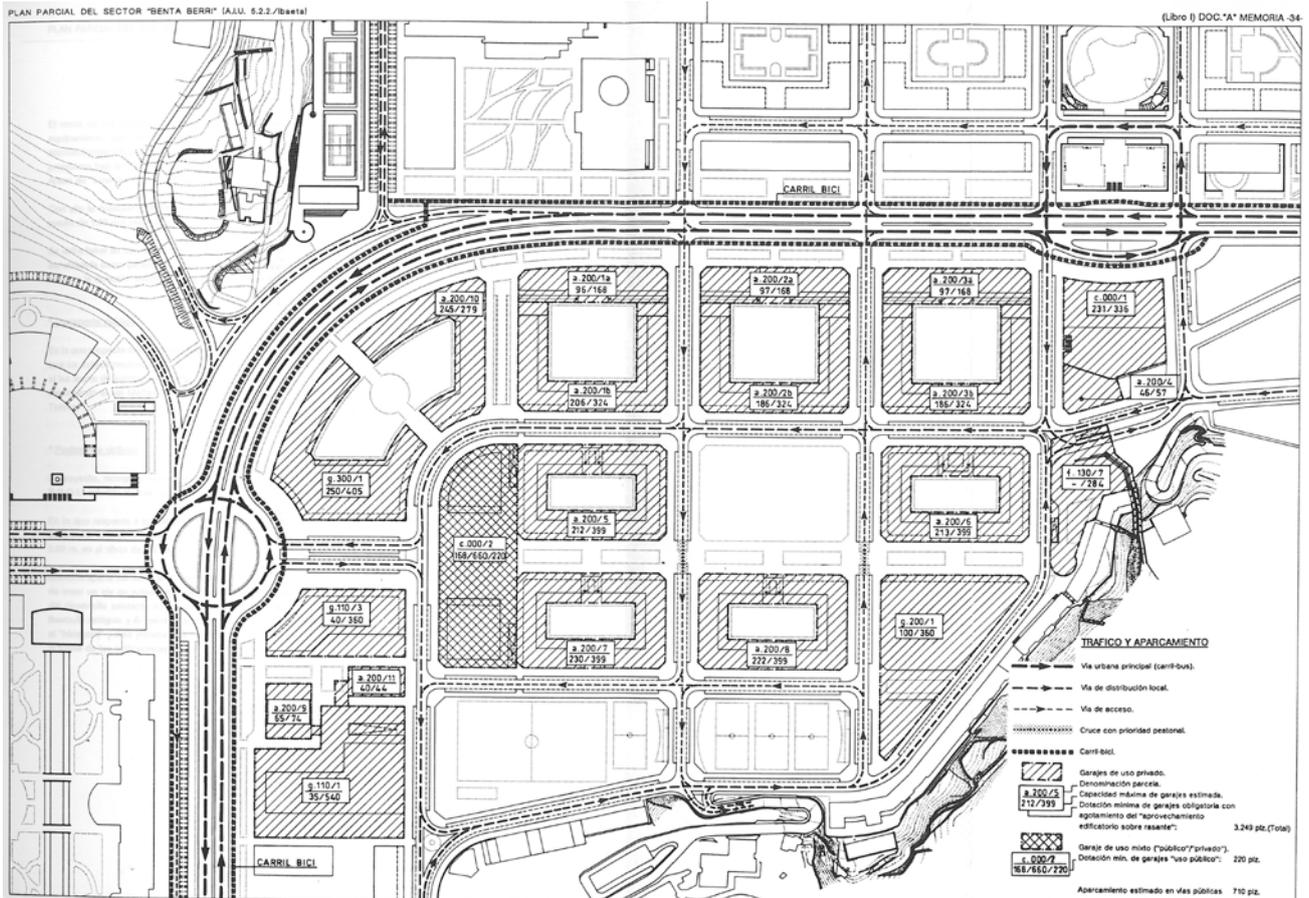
y Fig. 92. Plano de Tráfico y Aparcamiento. Plano Sistema Local Espacios Libres - P.P.O.P.G. Pág. 34 y 37
